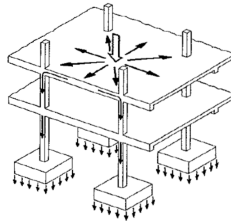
Sistemas estructurales Fuente: J. Calavera - Proyecto y Cálculo de Estructuras de Hormigón
